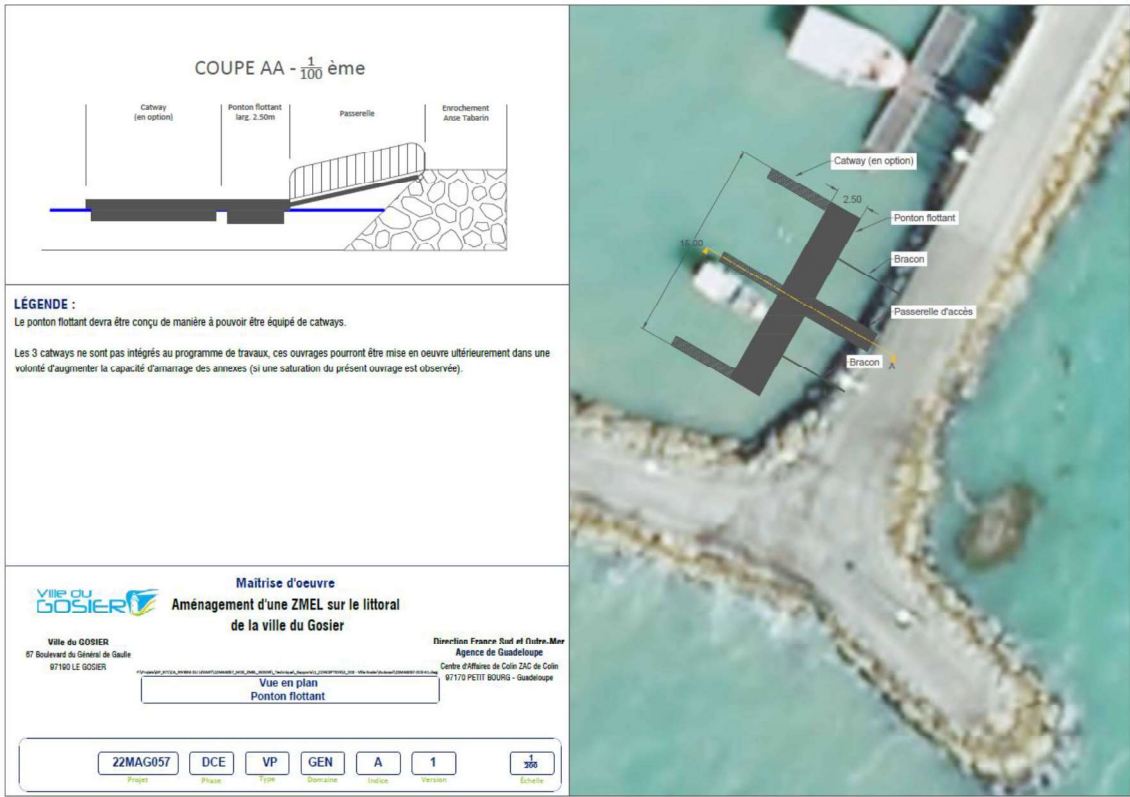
Plan et coupe du flonton flottant (Source : Suez Consulting, 2025)
